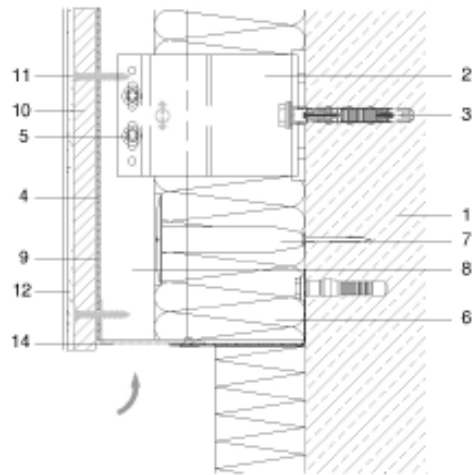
Detalhe construtivo de corte no arranque do sistema [78].
